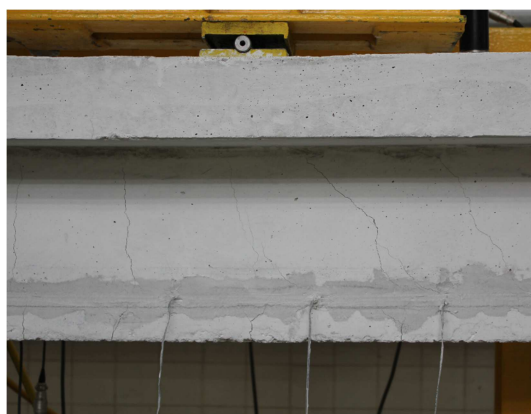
Pormenor da fendilhação do betão nos instantes iniciais do ensaio da viga V9
